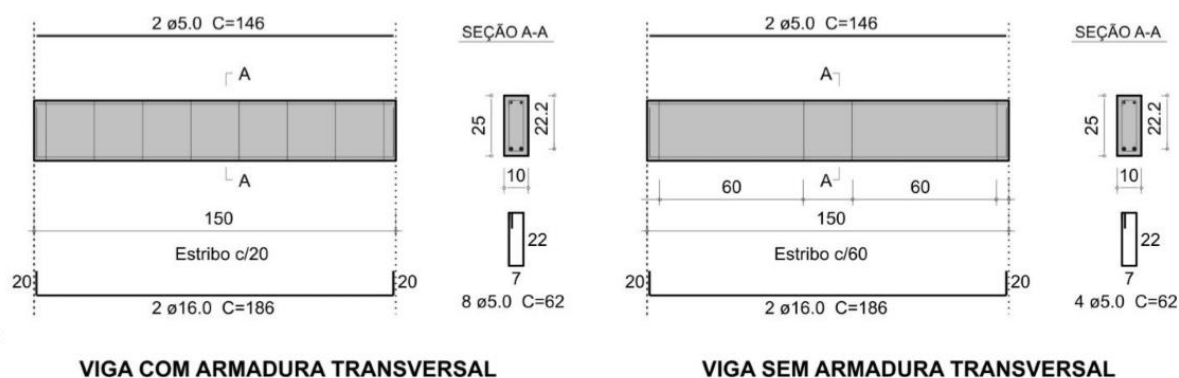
Detalhamento das armaduras das vigas, medidas em cm, desenvolvidas por Savaris (2016).
